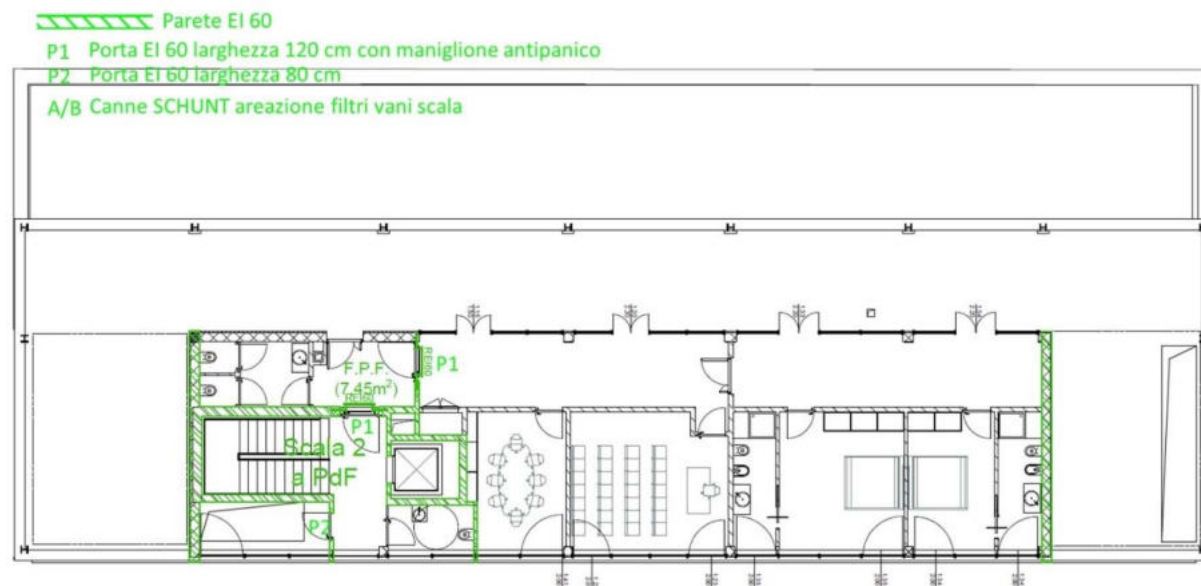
Pianta piano Quarto – Layout distributivo.
